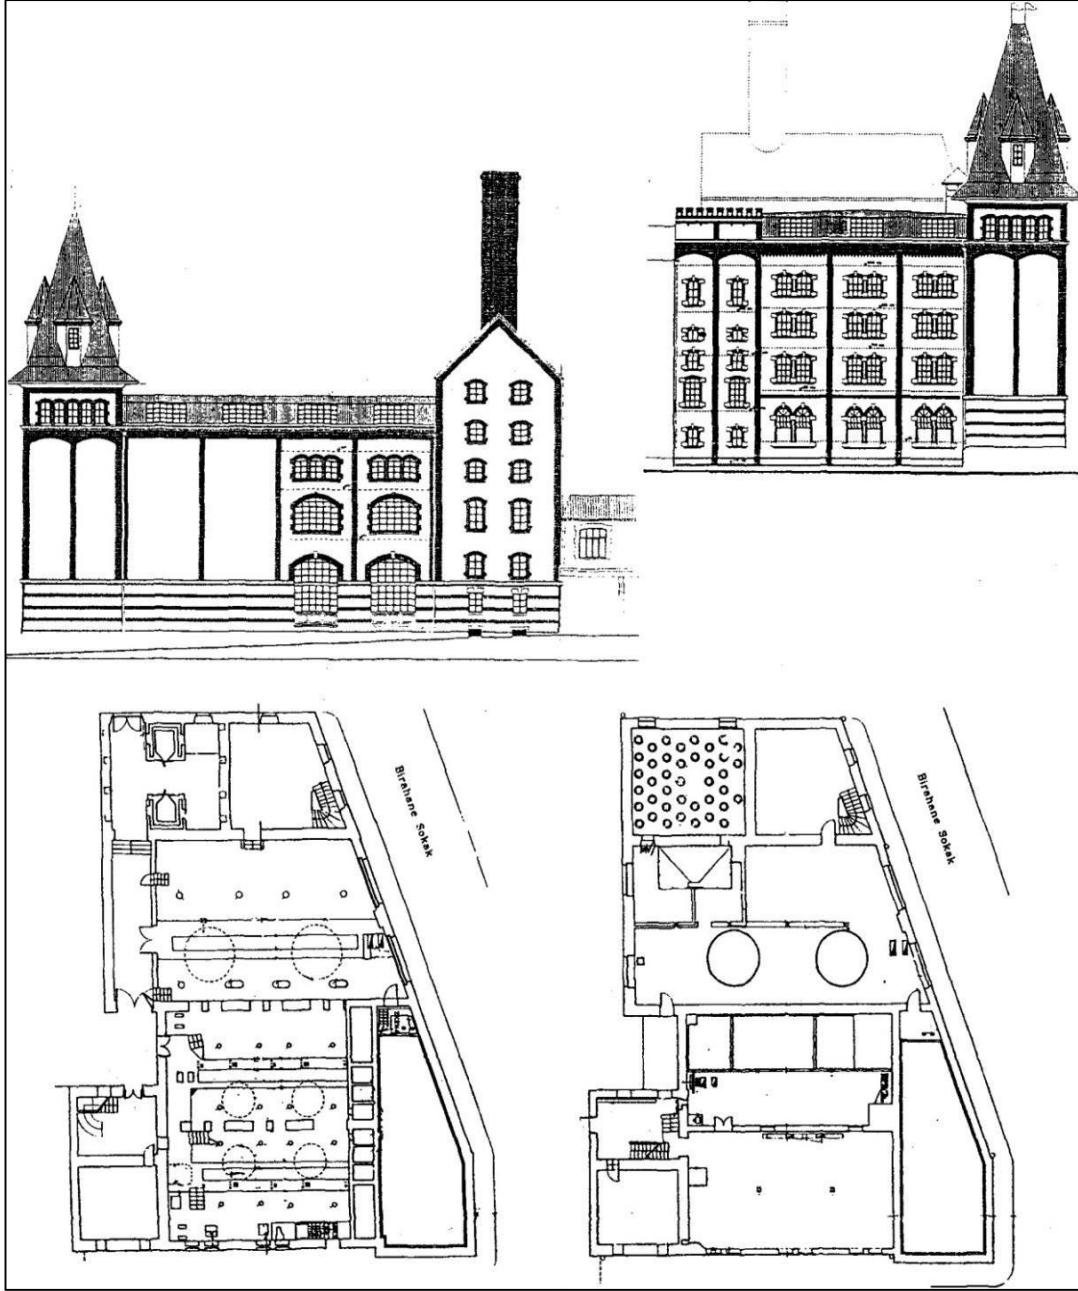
Silahtarğa Elektrik Fabrikası üretim birimleri planı ve görünüşler (Köksal, 2005).
